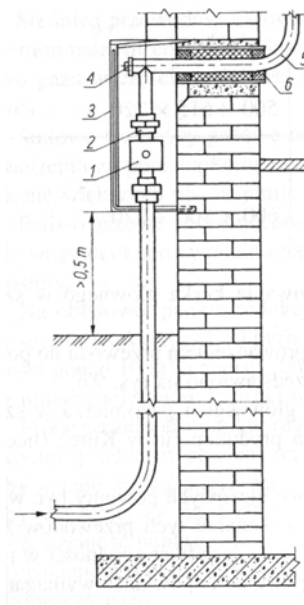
Przyłącze gazowe z rur polietylenowych [3]
